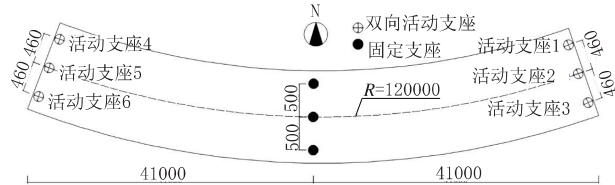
钢箱-混凝土组合曲线梁桥平面布置图(单位:mm)
